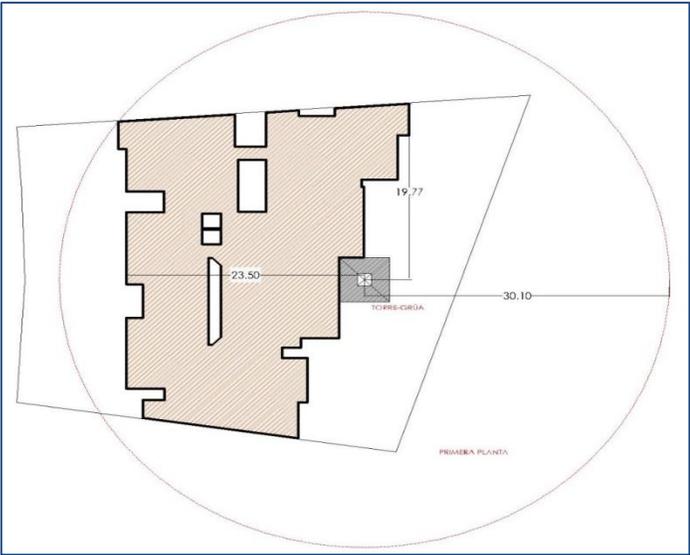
Layout del Proyecto Piso 1. Fuente: Elaboración Propia
